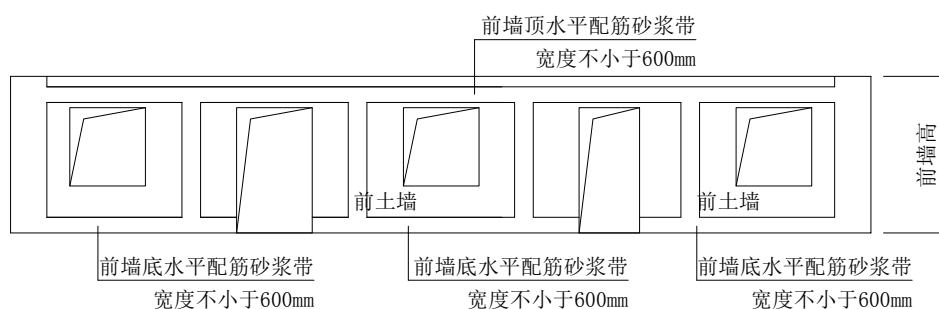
五间房前墙水平配筋砂浆带的布置示意图
